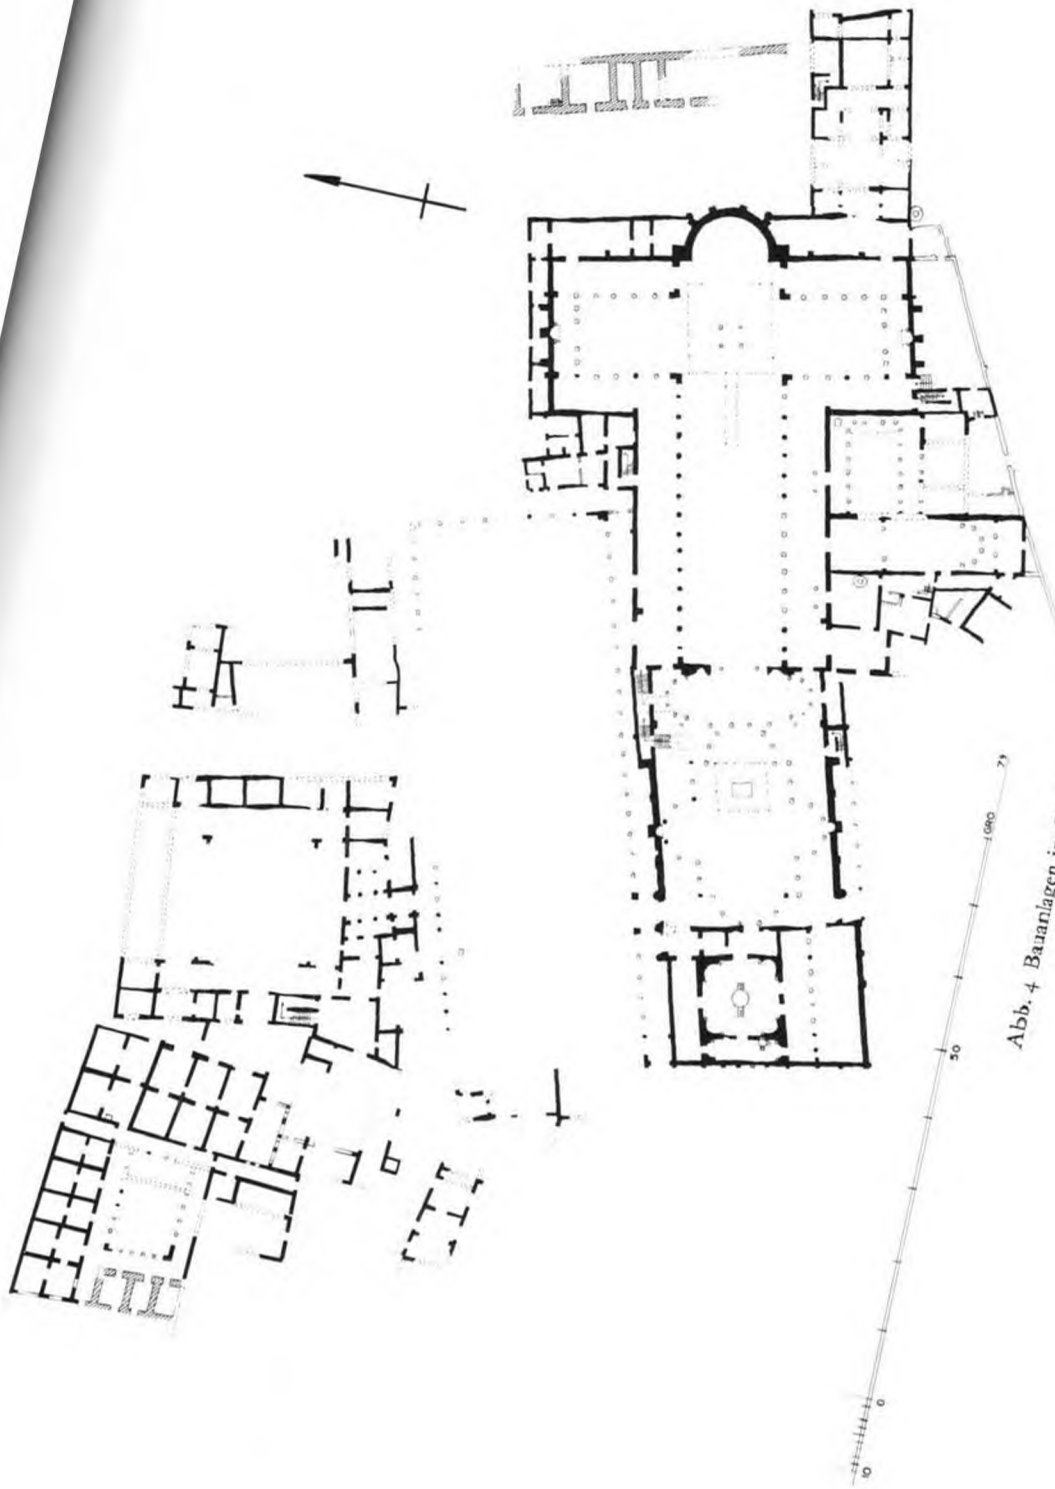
Bauplan im Kultbezirk der Menasstadt.
